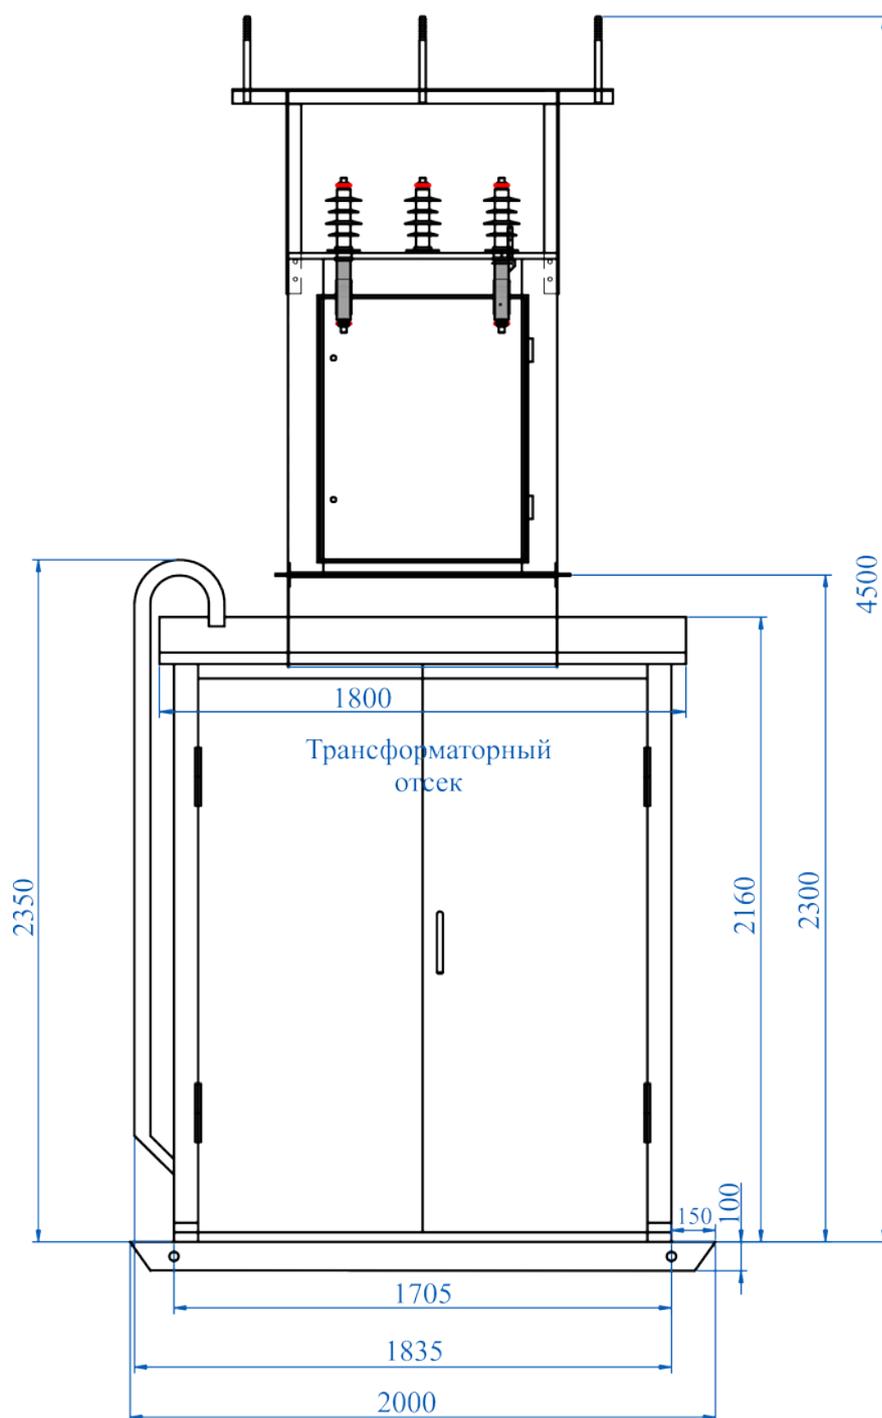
Внешний вид и габаритные размеры КТПН – 100 кВ
